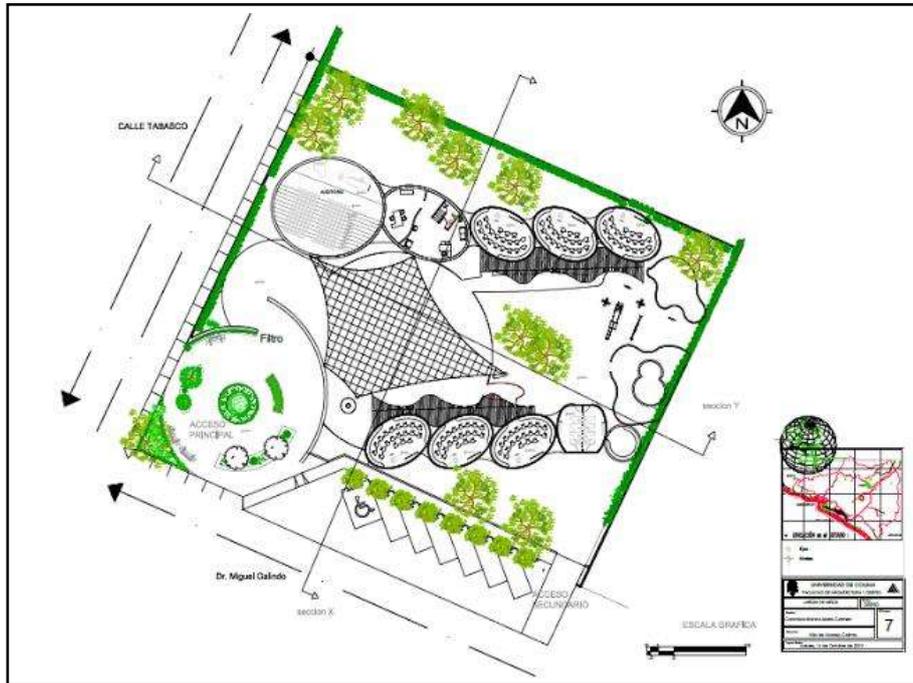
Planta arquitectónica del proyecto de jardín de niños "Mickey y Minnie" en ciudad de Villa de Álvarez, Colima. Fuente: Architectuur
